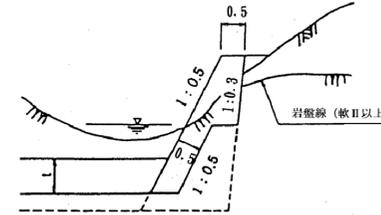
側壁護岸の構造（岩盤（軟Ⅱ以上）の場合）
